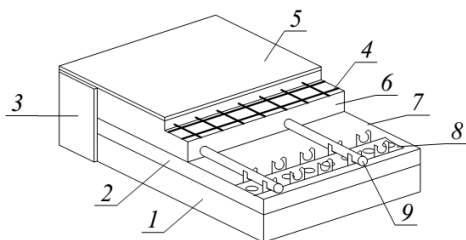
Мокрая укладка с использованием опорной шины: 1 – несущее перекрытие; 2 – тепловая изоляция; 3 – краевая пленка; 4 – проволочная решетка; 5 – напольное покрытие; 6 – монолитный пол; 7 – полиэтиленовая пленка; 8 – фиксирующая шина; 9 – труба
